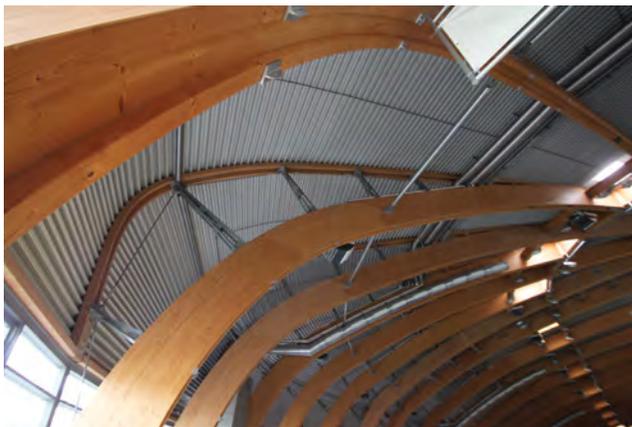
Erfurt, Eisschnelllaufhalle, Eckaufständerung, Aufnahme April 2011
